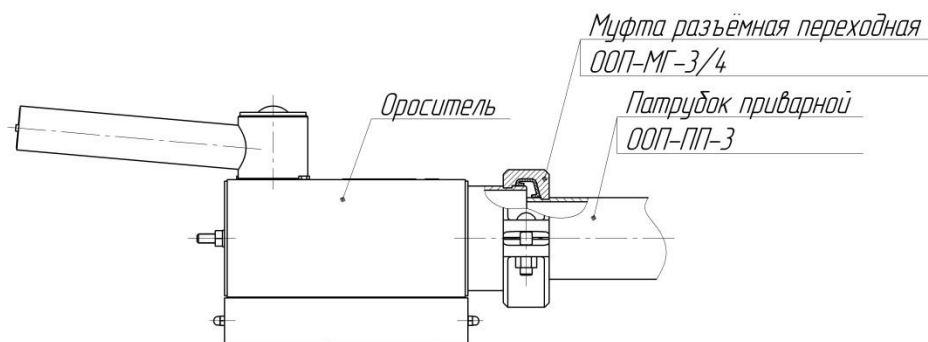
Схема подключения оросителя ООП с расходом 6 л/с к трубопроводу
